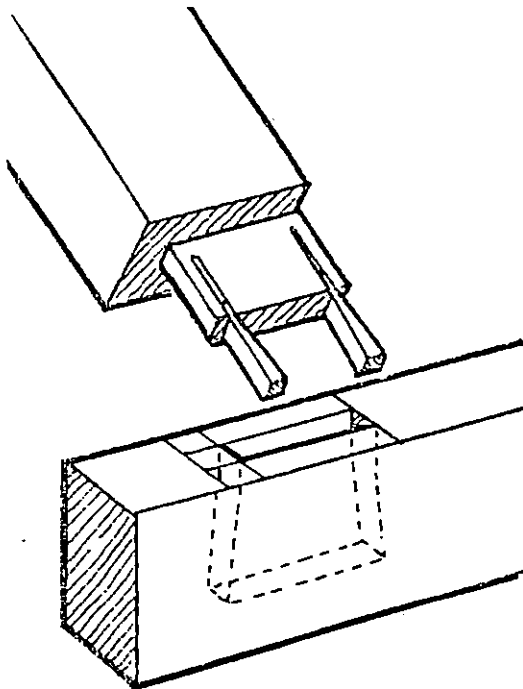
Ensamble de espiga de contrachaveta listo para su montaje.
